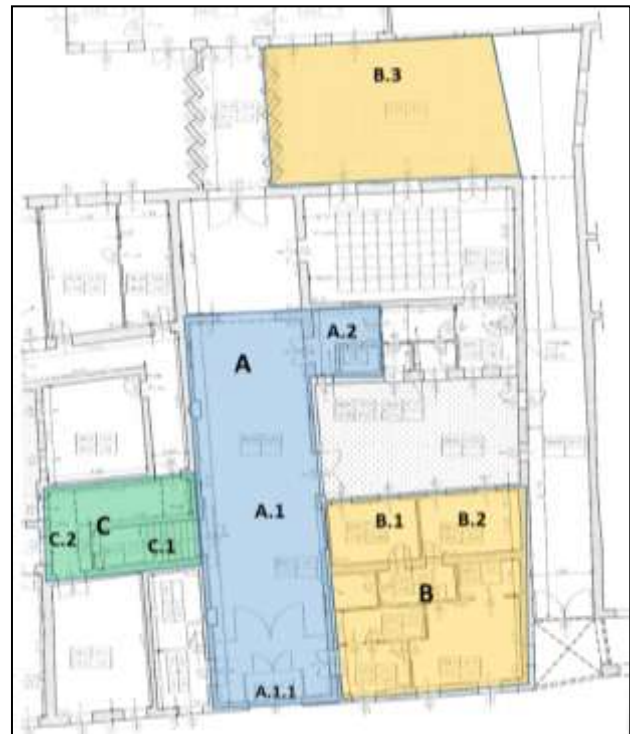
Planimetria del piano terra di Palazzo Wollebörg
